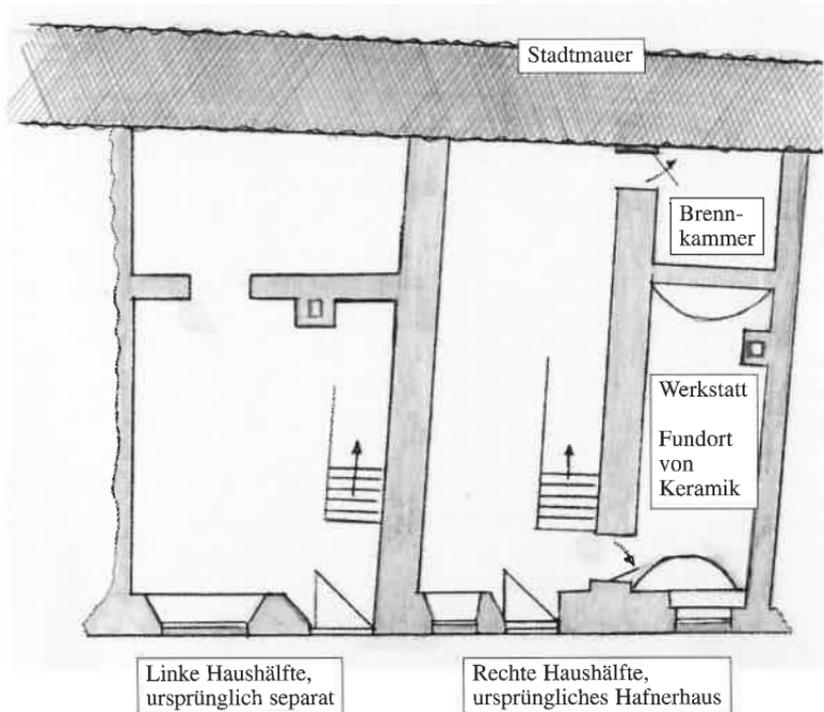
Abb. B: Grundriss des Hafnerhauses vor der Erweiterung in der Mitte des 19. Jh.
